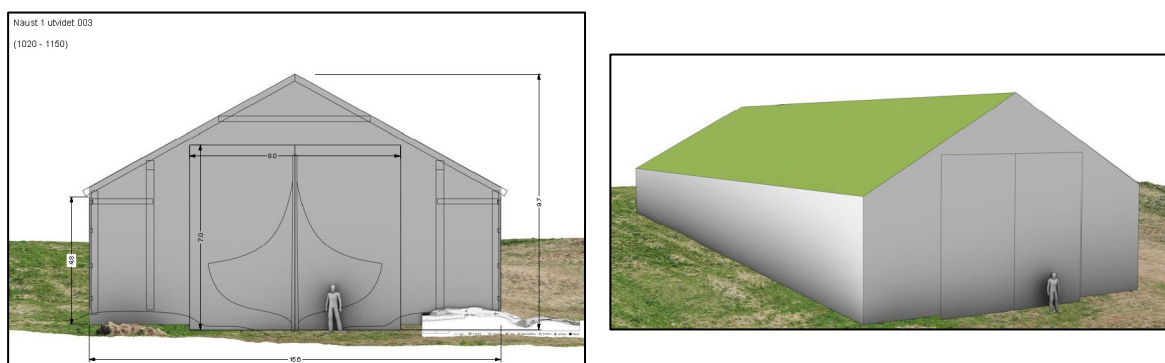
Rekonstruksjon av opprinnelig tuft 1 jernaldernaust i landskapet. Illustrasjon: Steinar Alvestad
